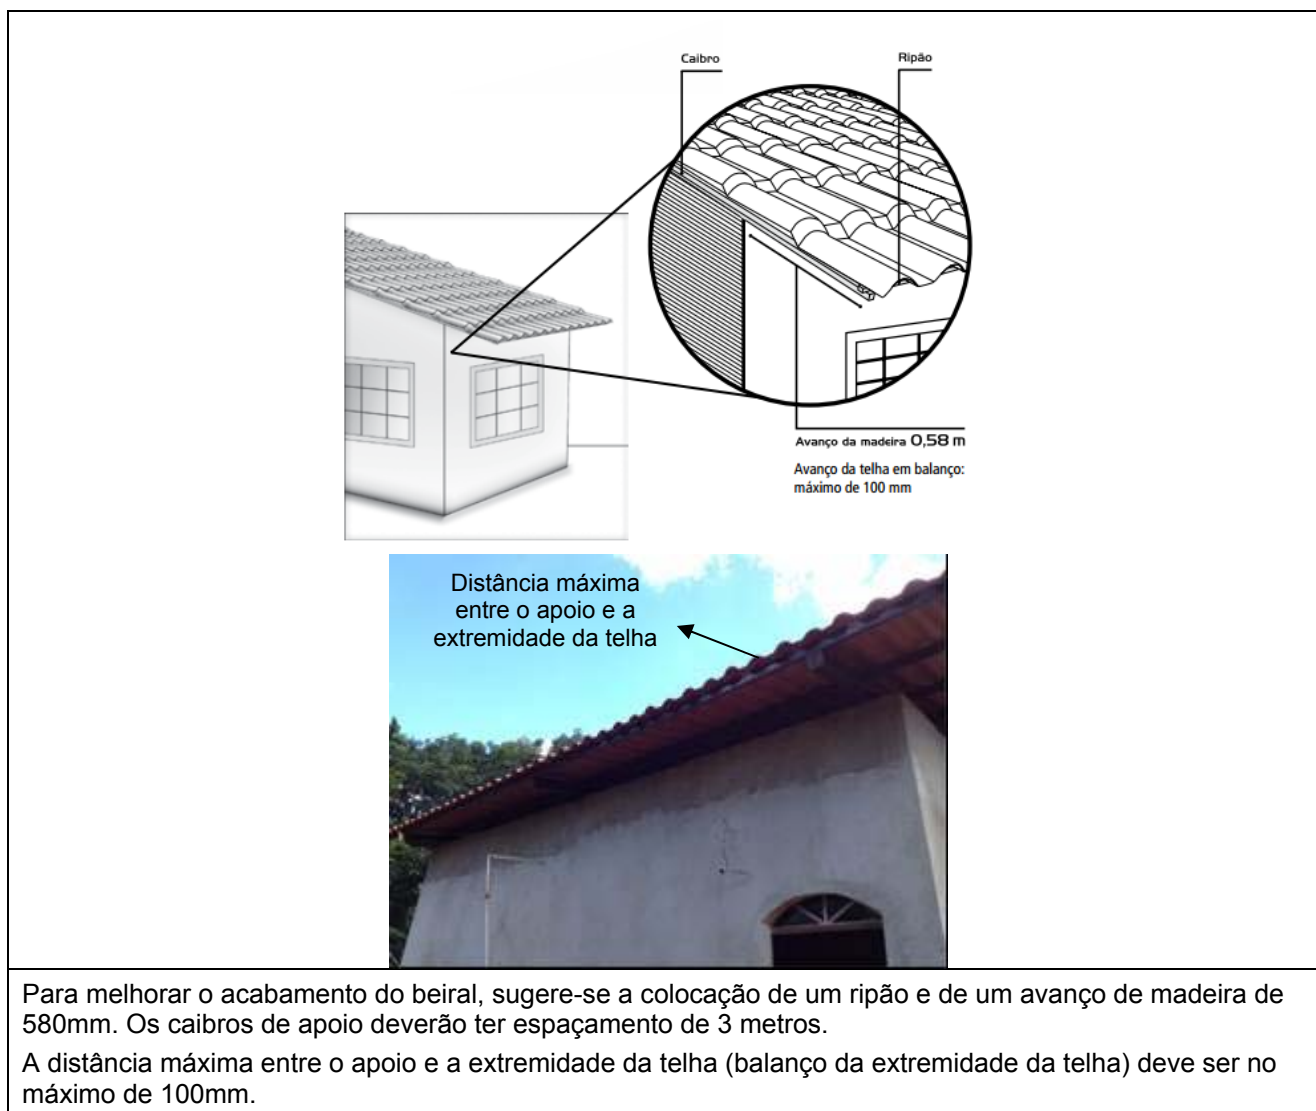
Ilustrações de telhado instalado em obra inspecionada
